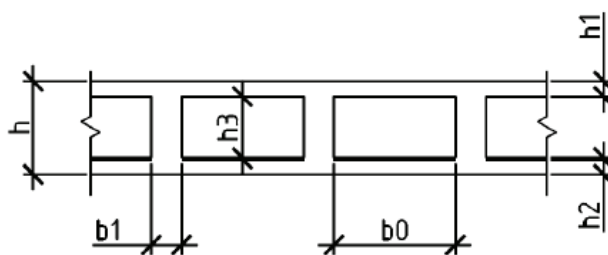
Схема геометрических размеров поперечного сечения многопустотного монолитного перекрытия
